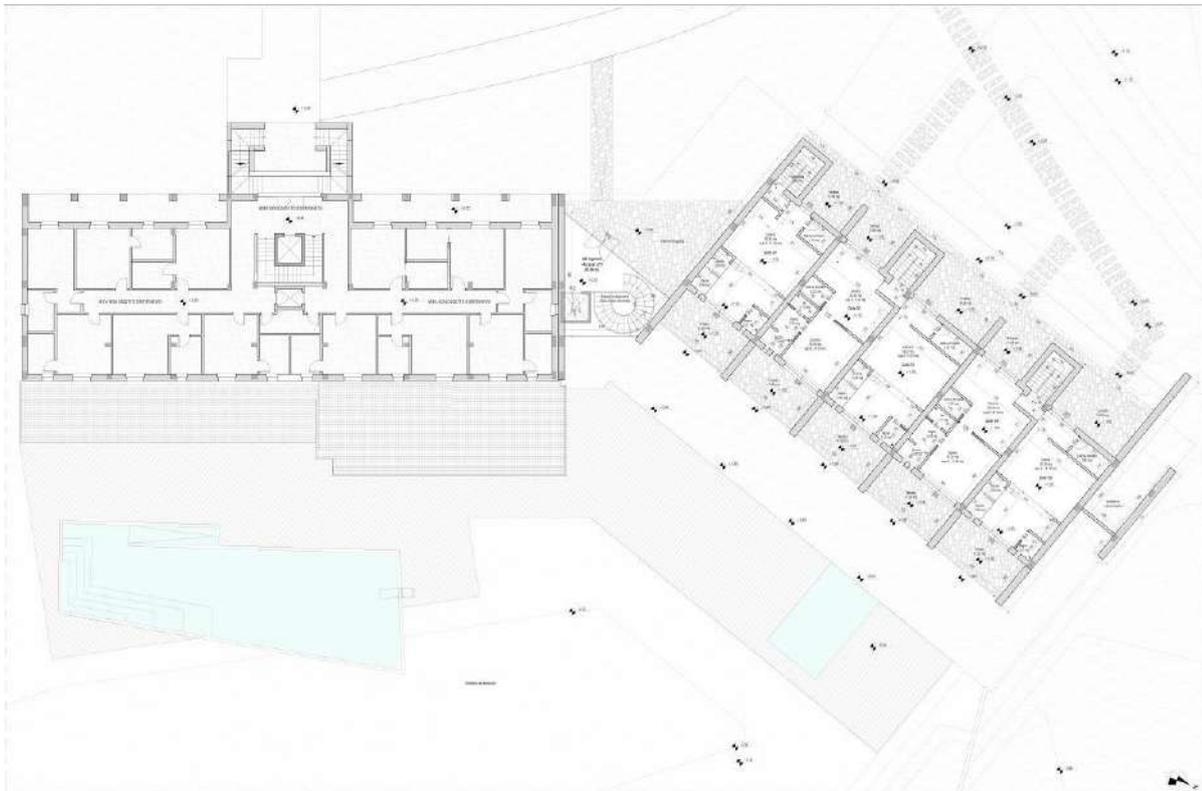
Progetto del Piano Terra – Stralcio Tav. PA05
